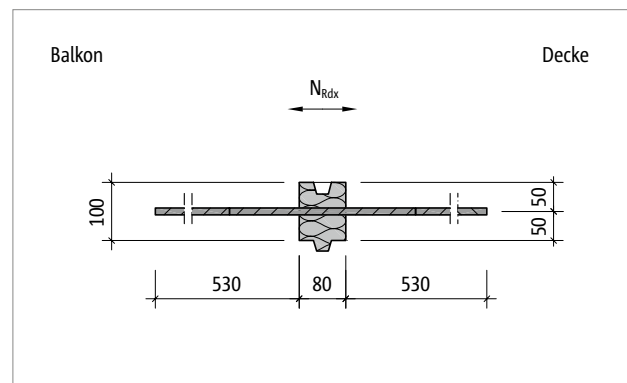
Schöck Isokorb® T Typ HP-NN2: Produktgrundriss
